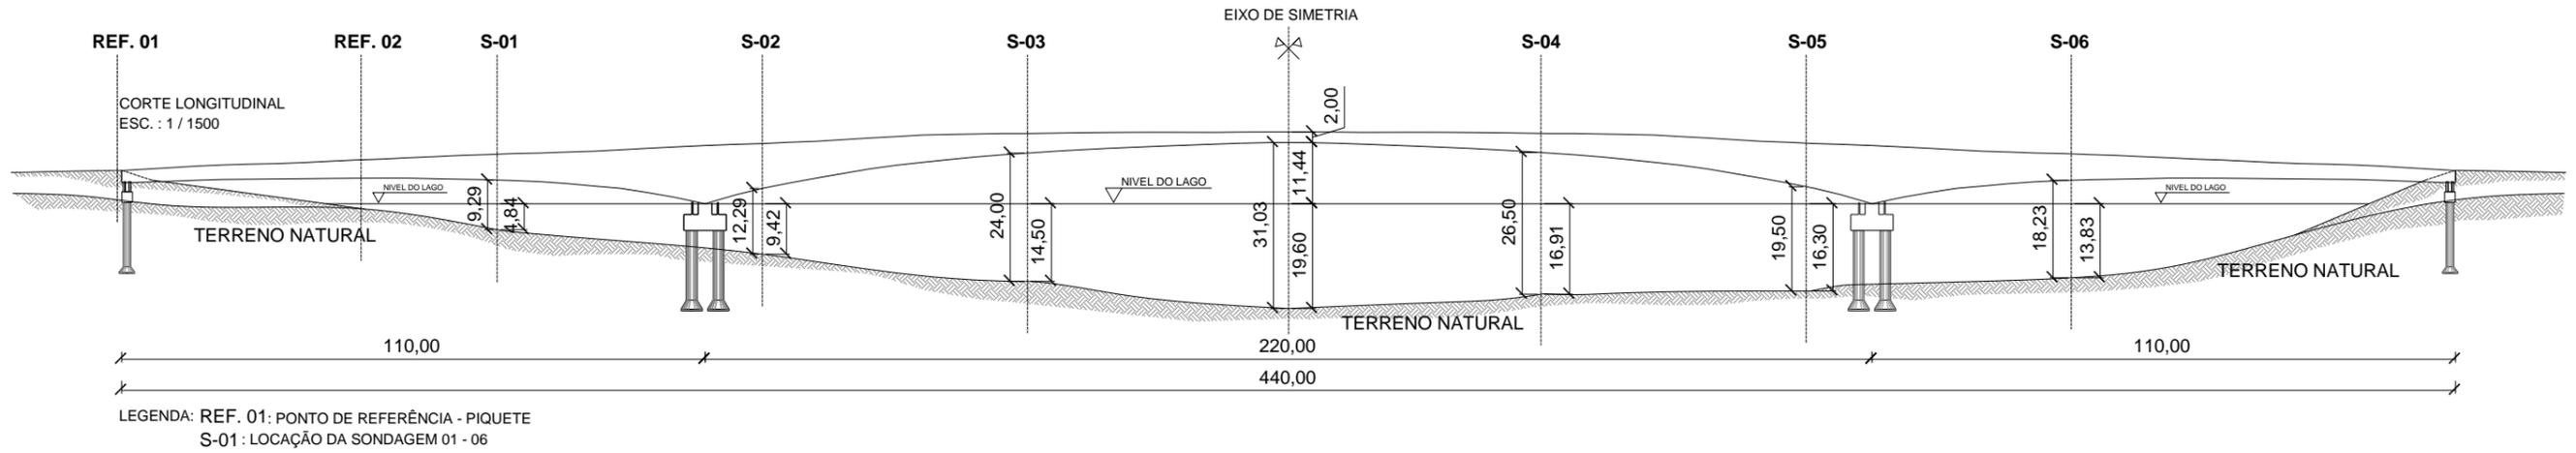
Batimetria demonstrando a topografia do lago no local de construção da Ponte Costa e Silva. Desenhos CAD realizados pelo autor segundo projetos originais. Fonte: (DE – DVO – NOVACAP, 1969).
